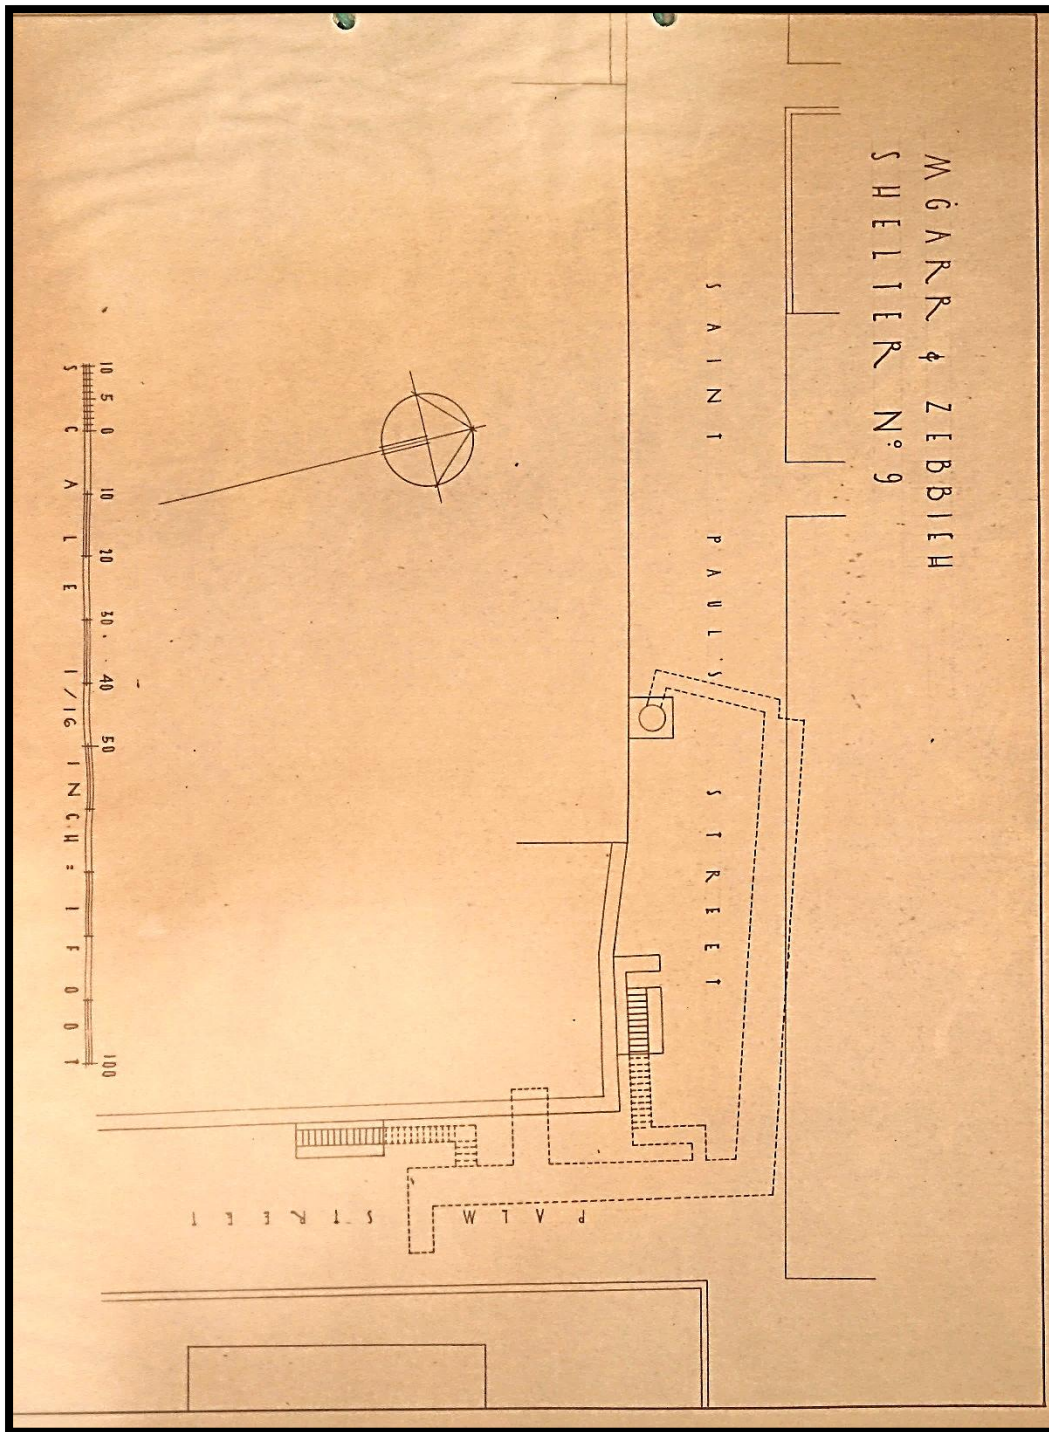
Planta do Abrigo nº9 "Saint Paul's Street – Palm Street."
